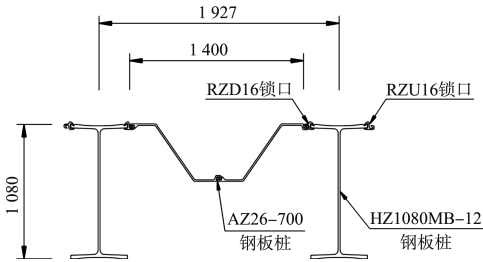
HZM/AZ 型组合钢板桩平面布置 (单位: mm)
